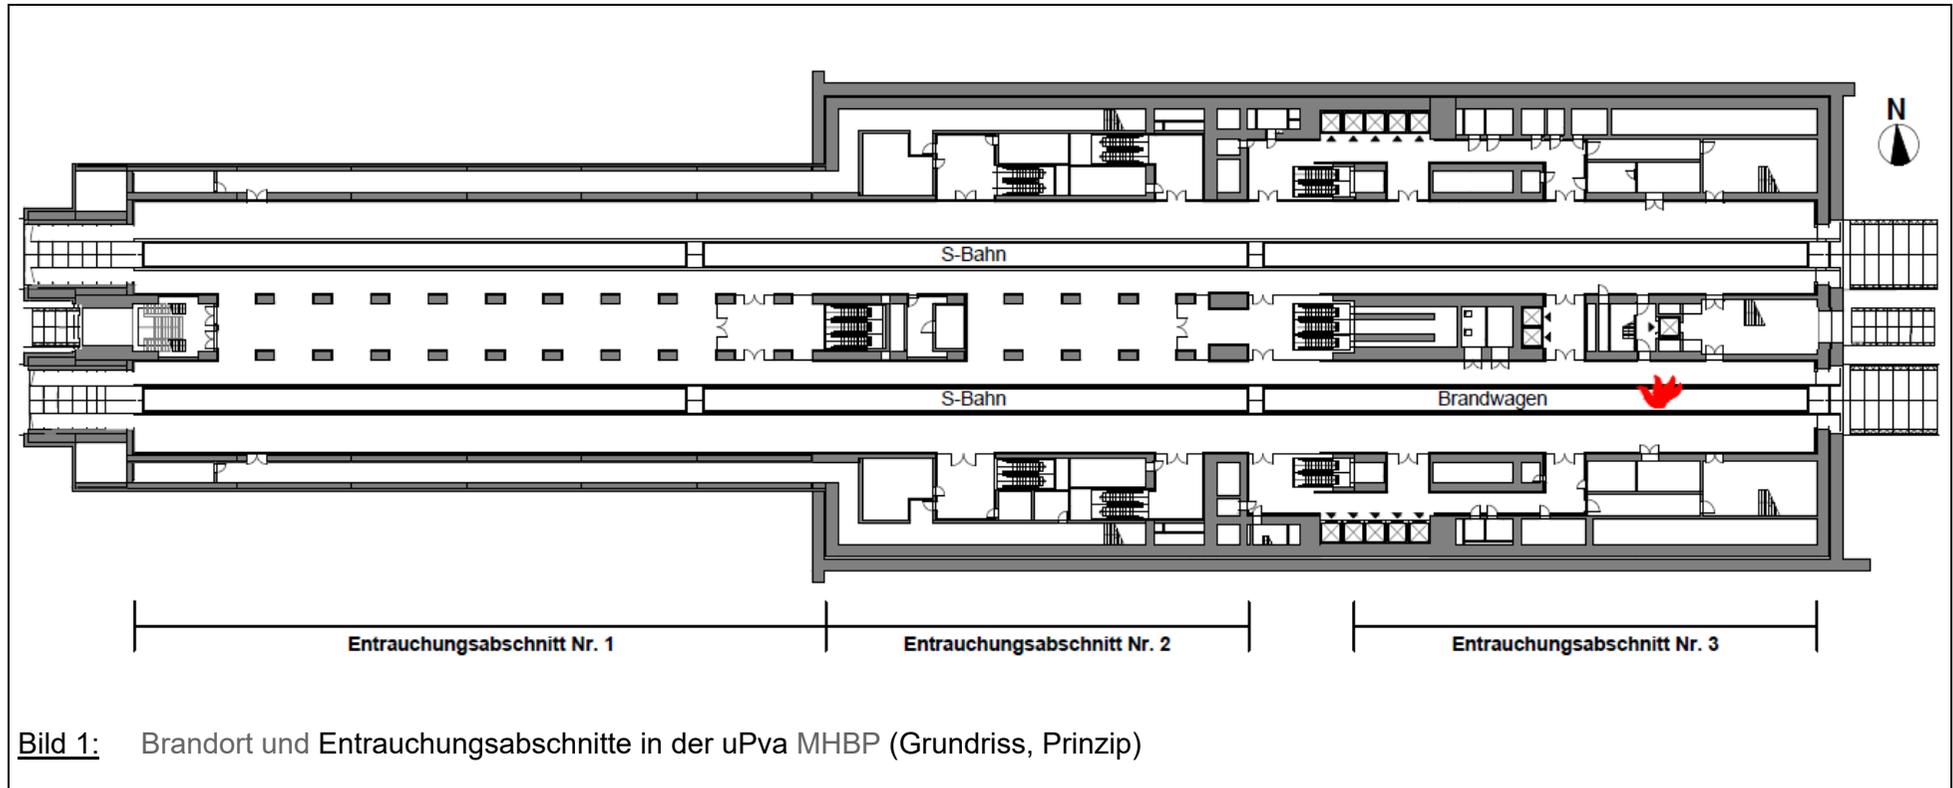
Brandort und Entrauchungsabschnitte in der uPva MHBP (Grundriss, Prinzip)
